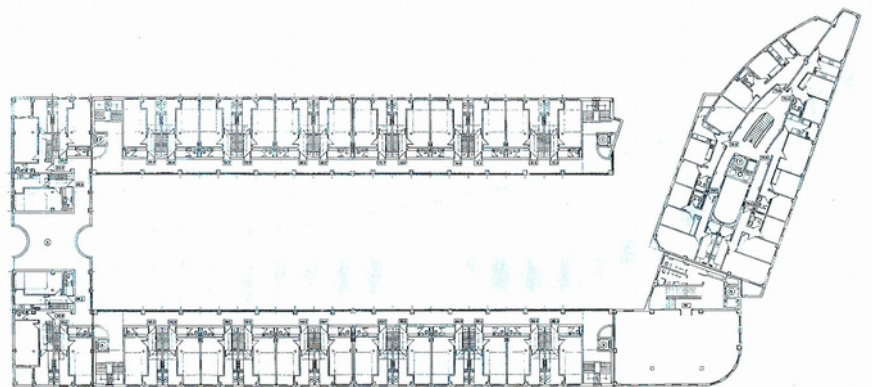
Planta tercera del inmueble de Orcasitas, viviendas y corredores abiertos perimetrales al patio. Fuente: Calle (1993)
